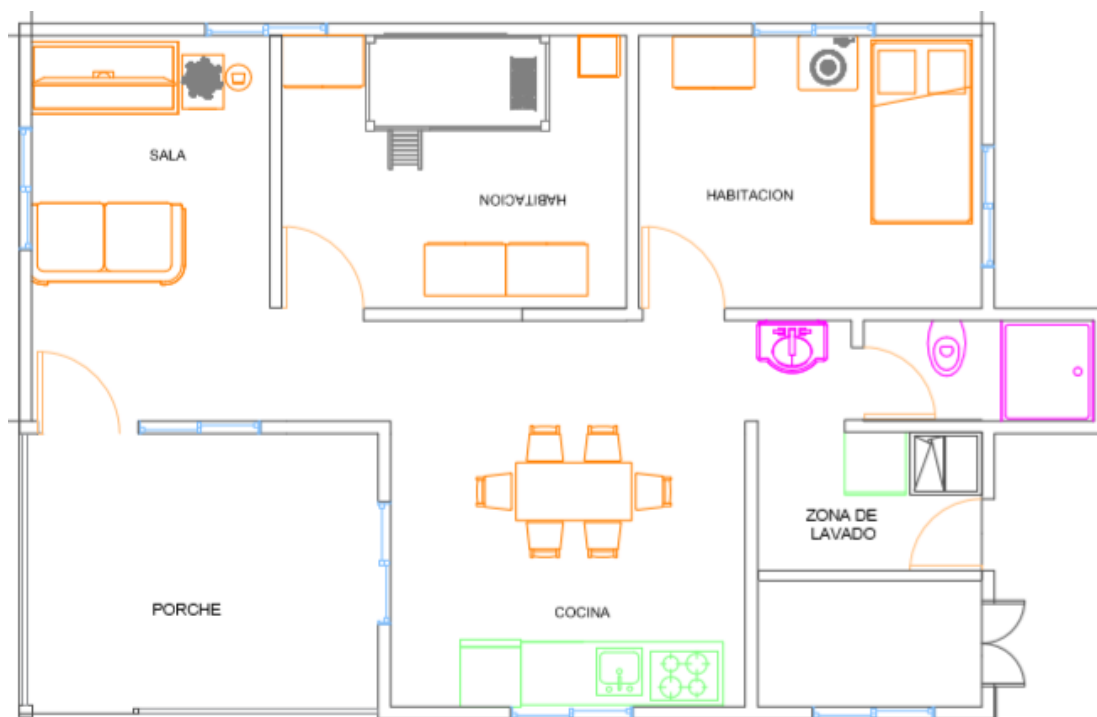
Esquema arquitectónico casa tipo mampostería tradicional. Adaptado de Diseño arquitectónico García Vega S.A.S.
